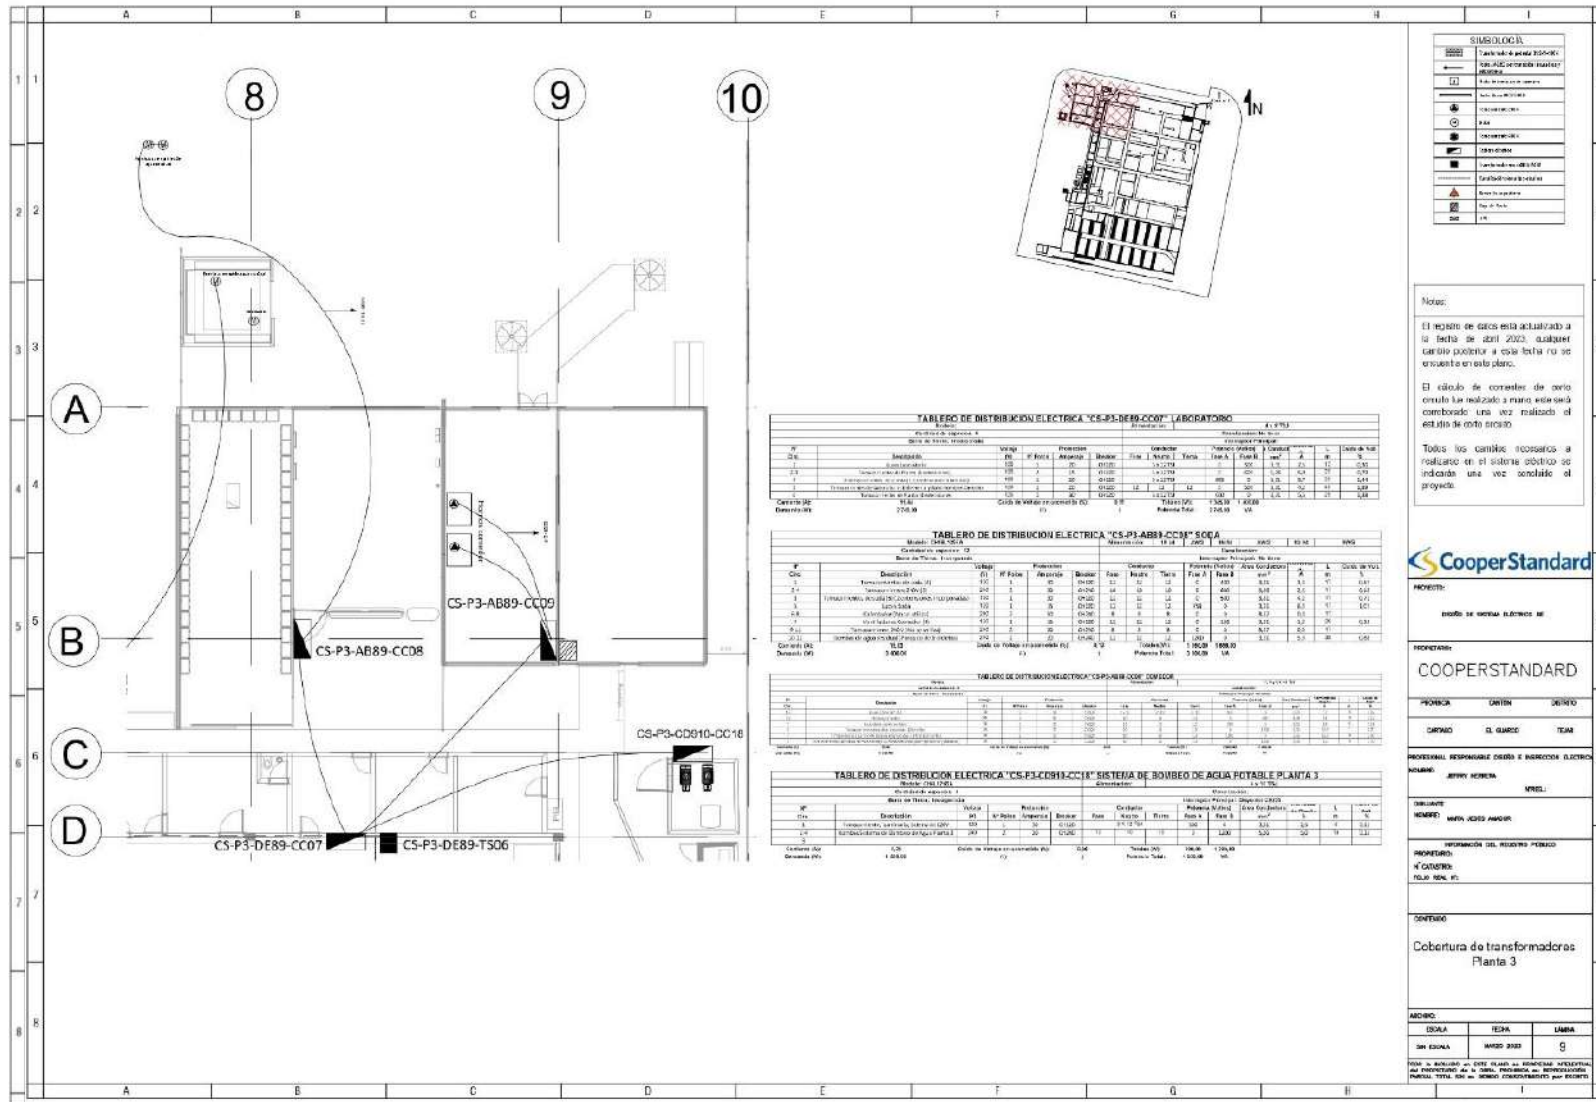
Cargas especiales a 240V, Planta 3 Fuente: Elaboración propia, realizado en AutoCAD (2023)
